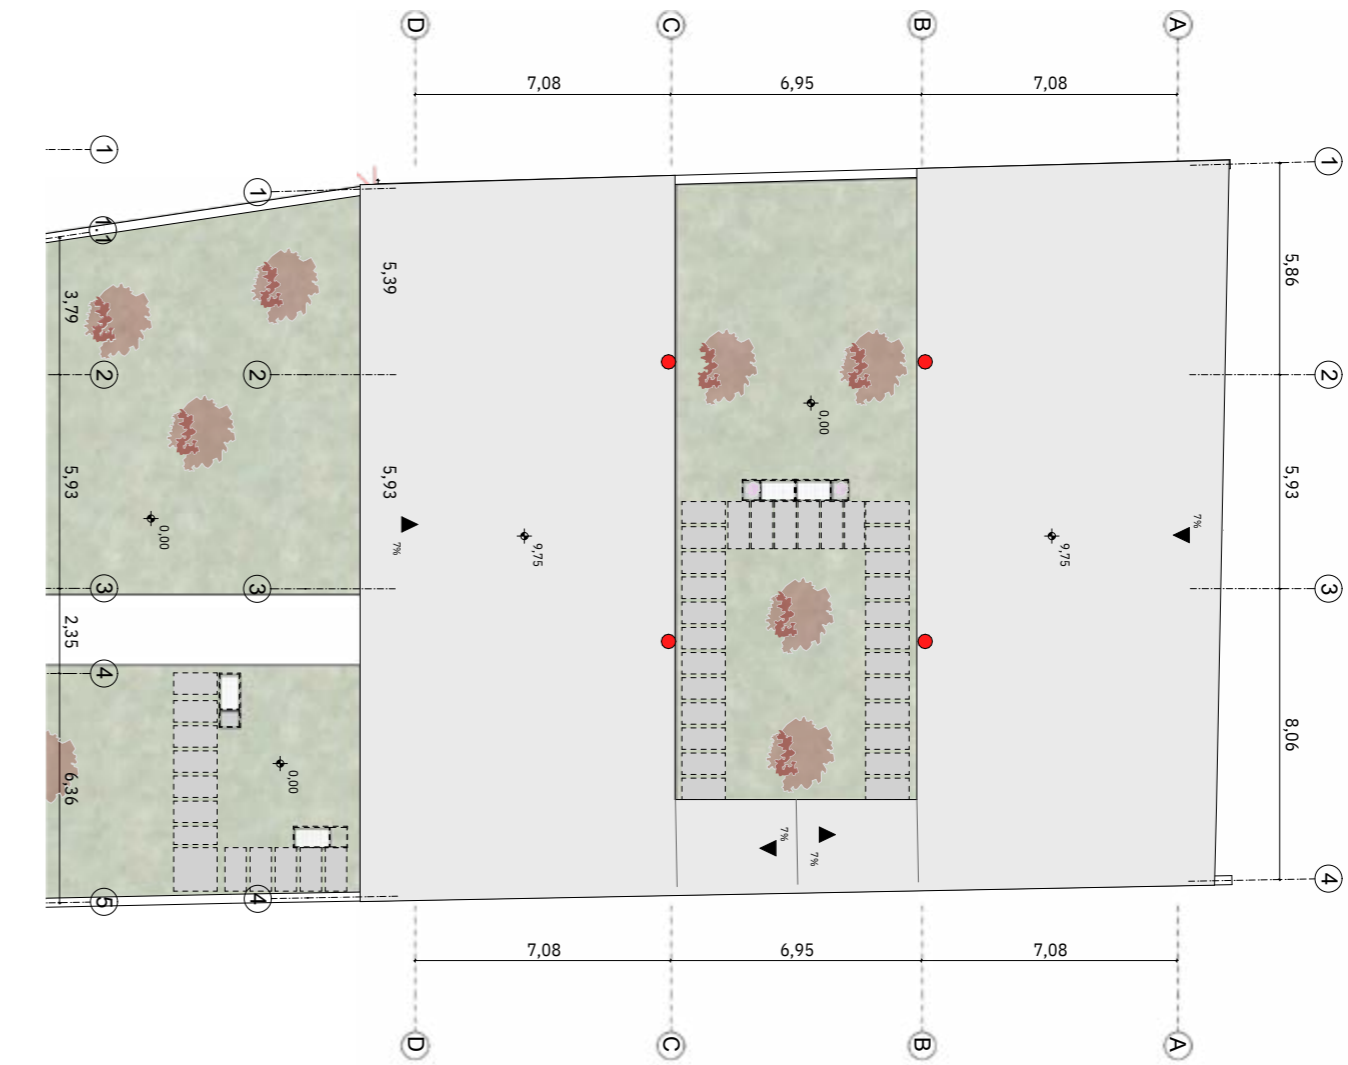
Planta de cubierta del proyecto - Bloque 3. Nota. Elaboración propia
